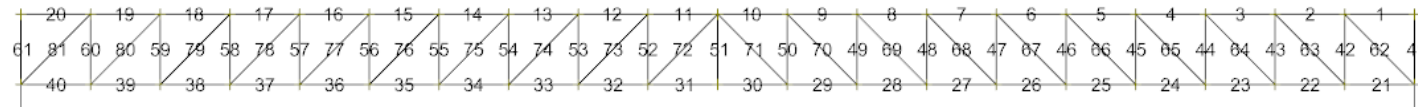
Zatěžovací stav (G6) Revizní lávka
